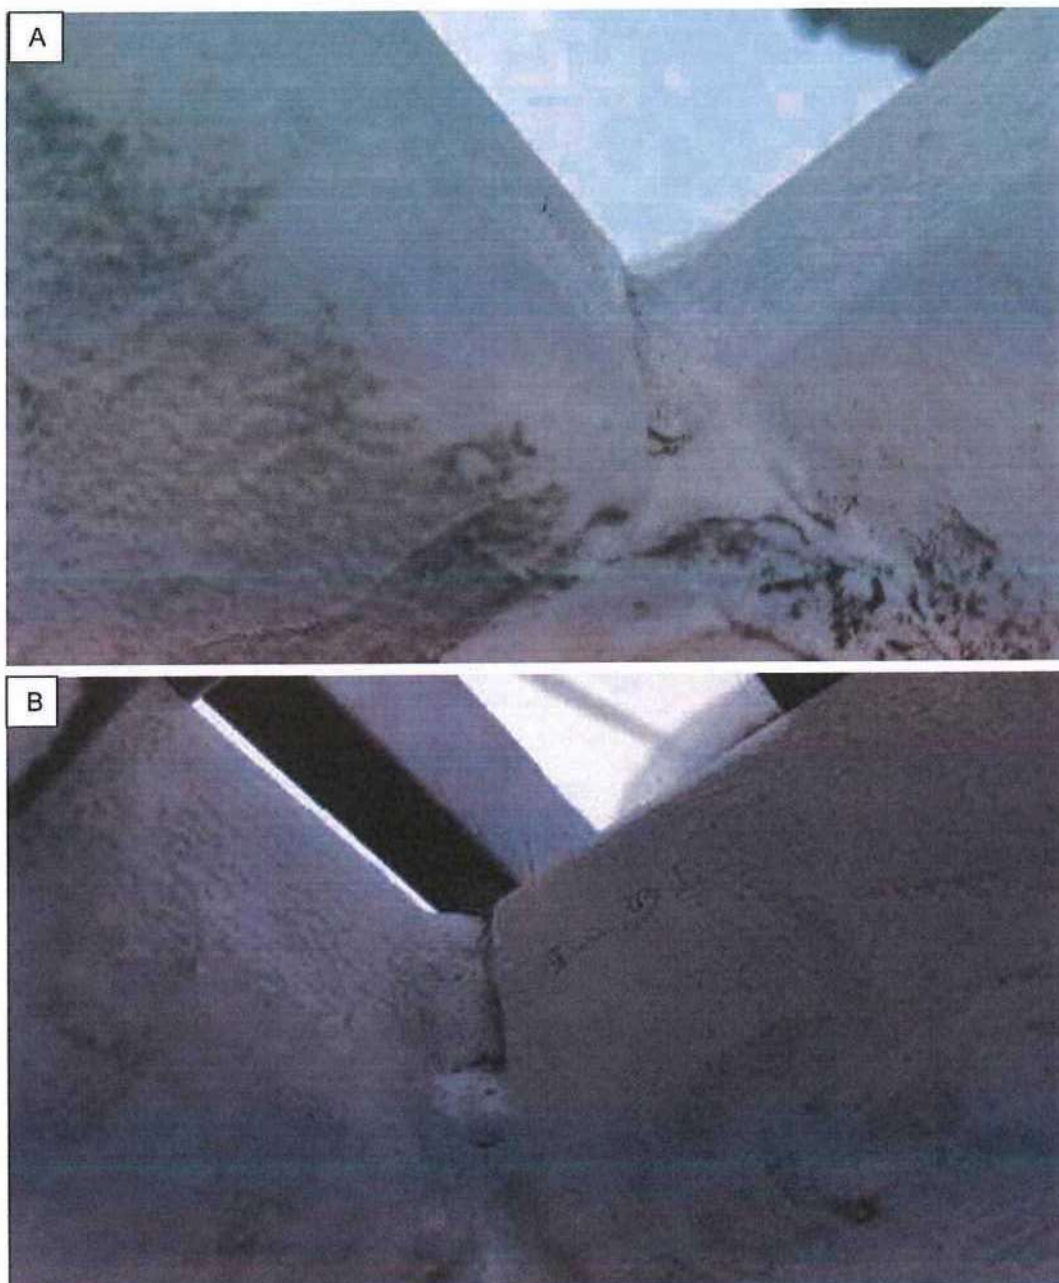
(A) Deposição insuficiente na junta soldada do tubo quadrado vertical com o horizontal no banzo superior do segmento da passarela 42-43 da passarela tangencial; (B) Deposição insuficiente na junta soldada do tubo quadrado vertical com o horizontal no banzo superior do segmento da passarela 52-53 da passarela tangencial
